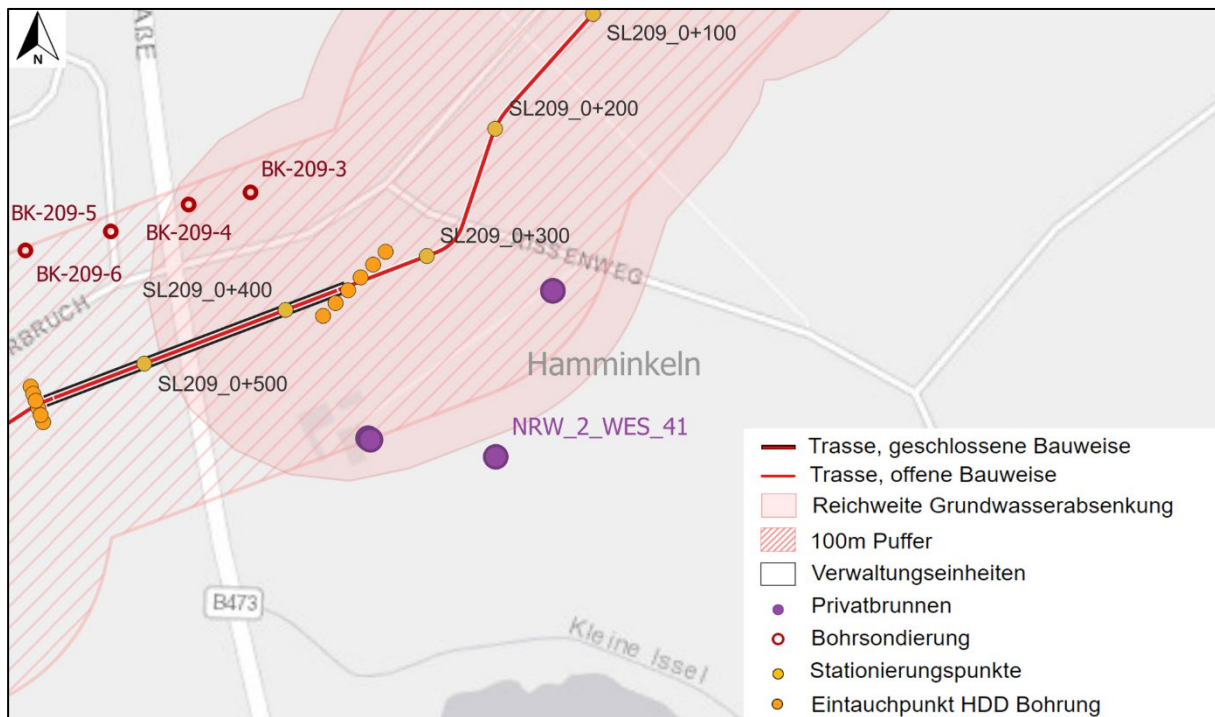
Lageplan Brunnen NRW_2_WES_41
